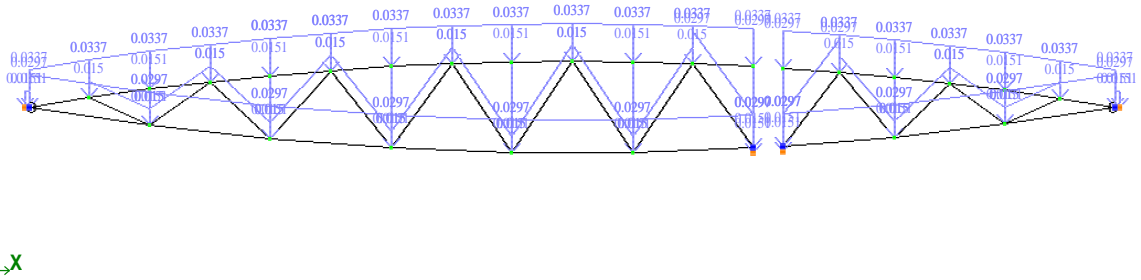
Загрузка №1. Собственный вес конструкции
